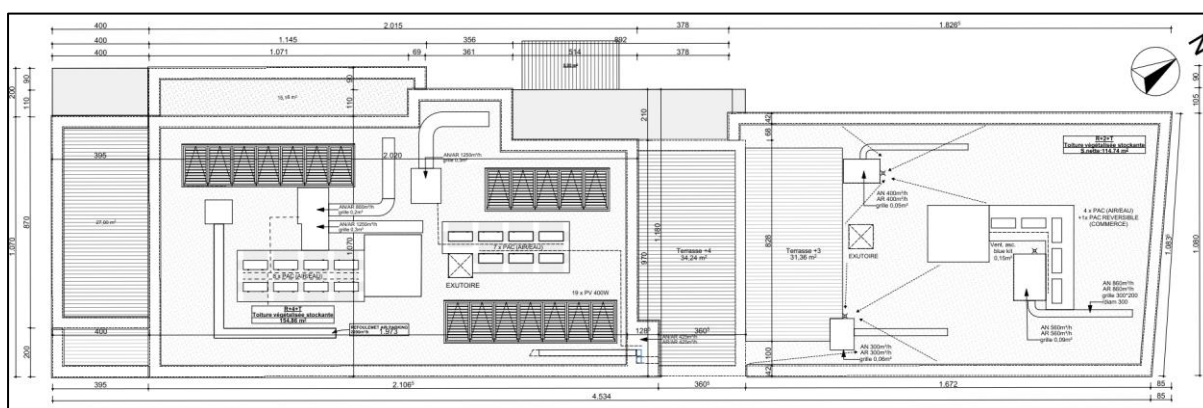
Localisation des panneaux solaires et pompe à chaleur en toiture du bâtiment 1(source : Plans PU)
